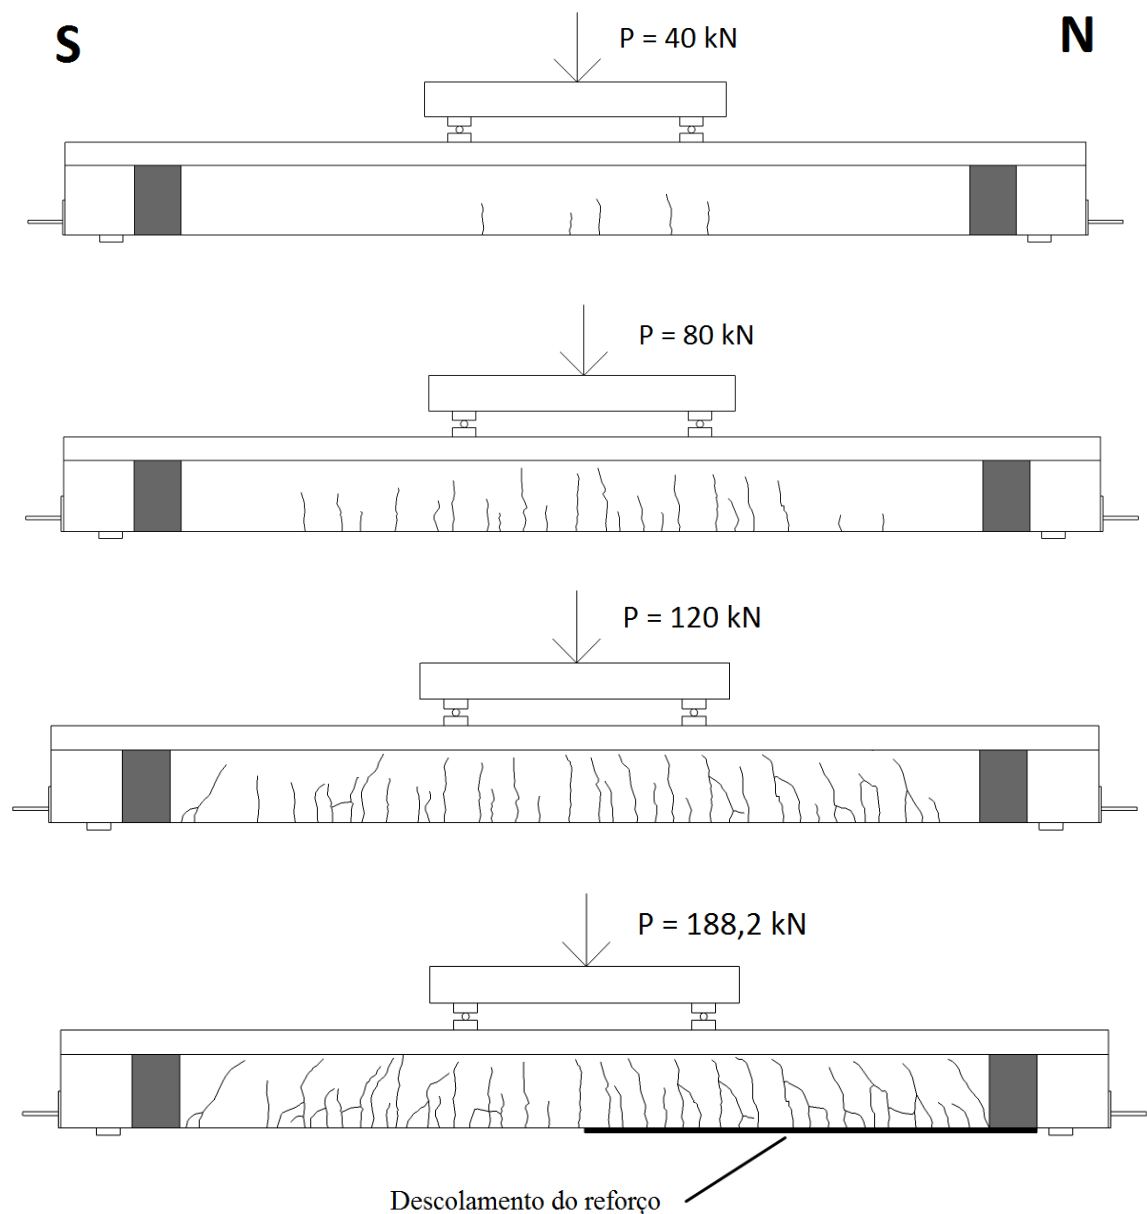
Evolução da fissuração na viga VA1 - CC
